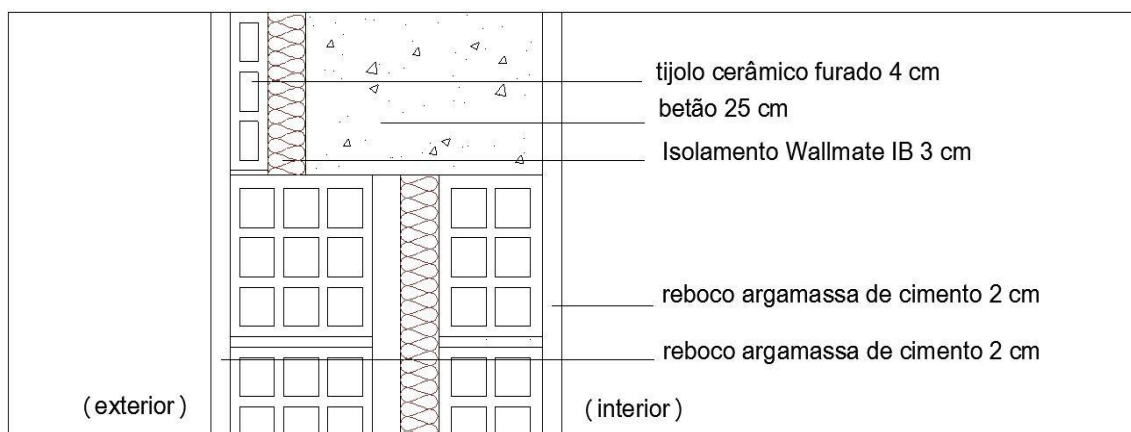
Pormenor construtivo de zona de ponte térmica plana (pilar ou talão de viga) da solução existente
